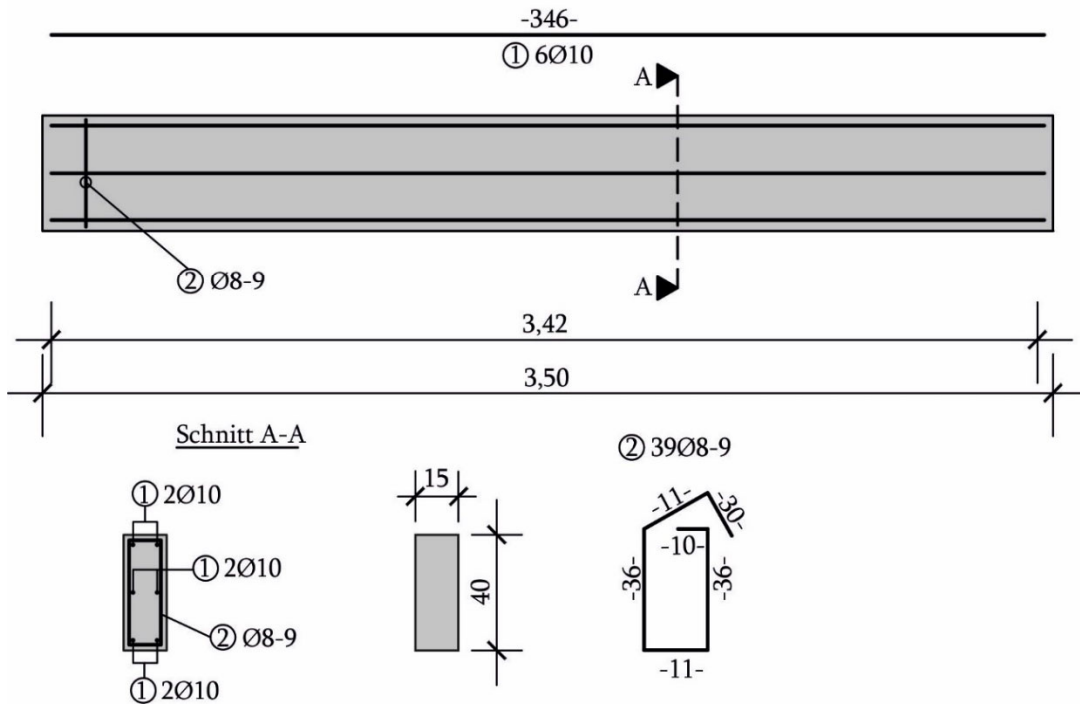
Schal- und Bewehrungsplan der Balken B6 – B8 (Balkentyp III)
